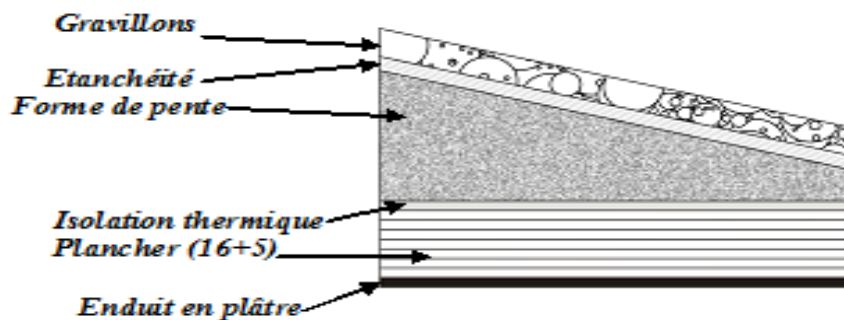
Plancher Corps creux terrasse inaccessible.
